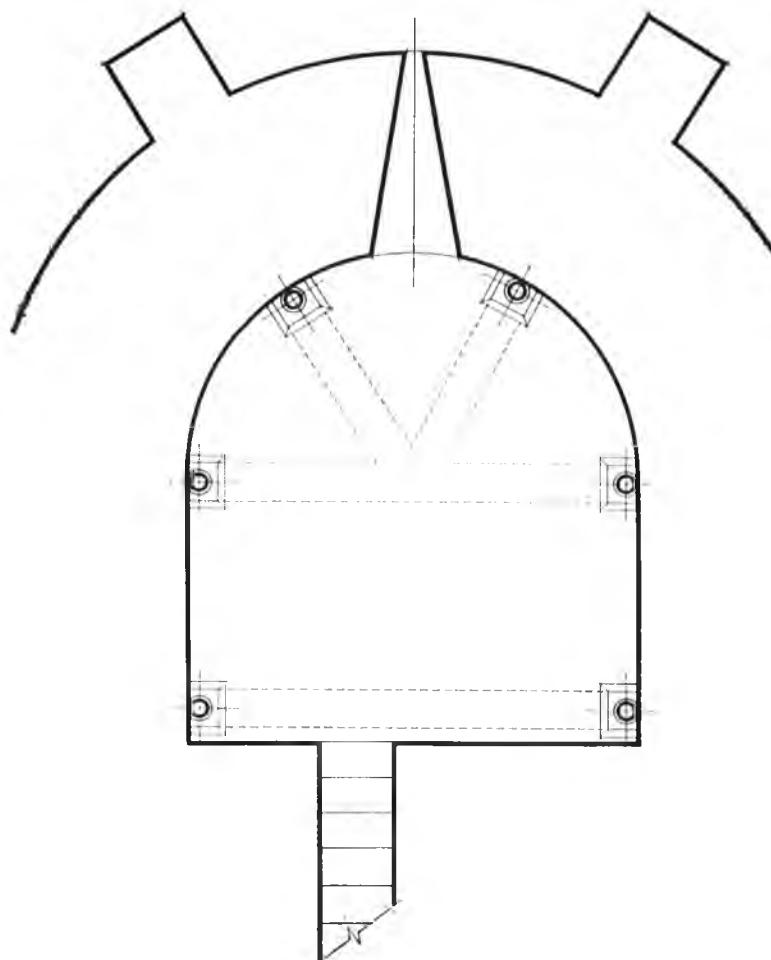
Iglesia parroquial de Orisoain; detalle de la cripta en planta y sección.
